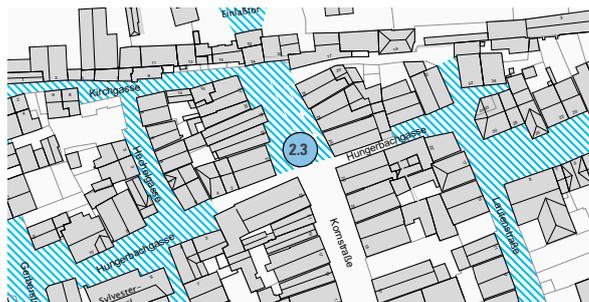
Übersichtslageplan Straßenraumsanierung
